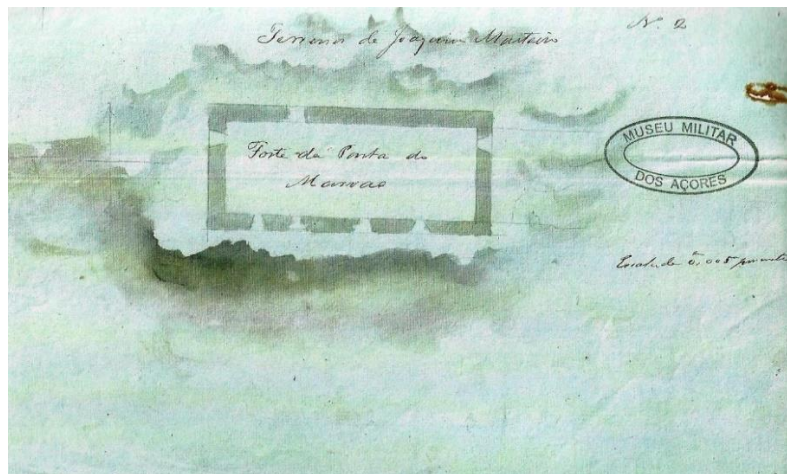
Forte da Ponta do Marvão, s.a., s.d. (séc. XVIII?), planta, ms., aguarelada, Museu Militar dos Açores. Apresenta planta retangular com 6 canhoneiras e entrada pelo lado de terra.
